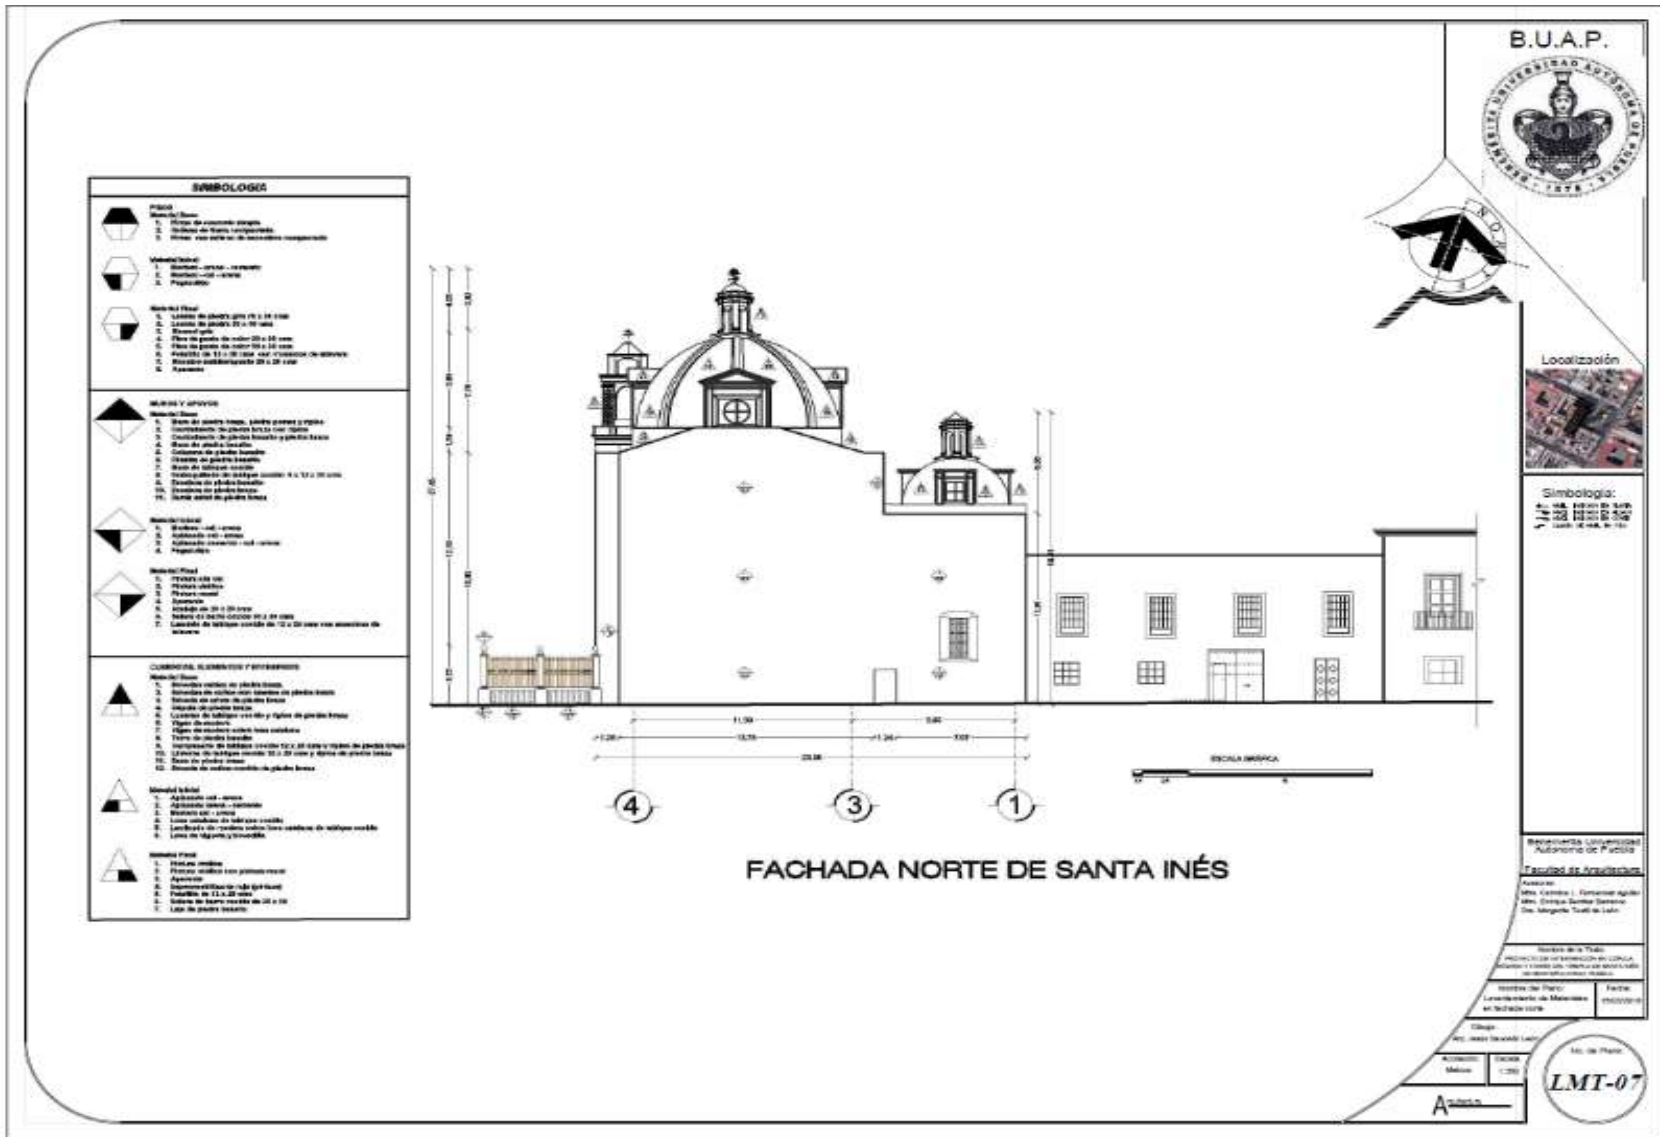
LMT-07. Levantamiento de materiales y sistemas constructivos Fachada Norte del Templo de Santa Inés.
